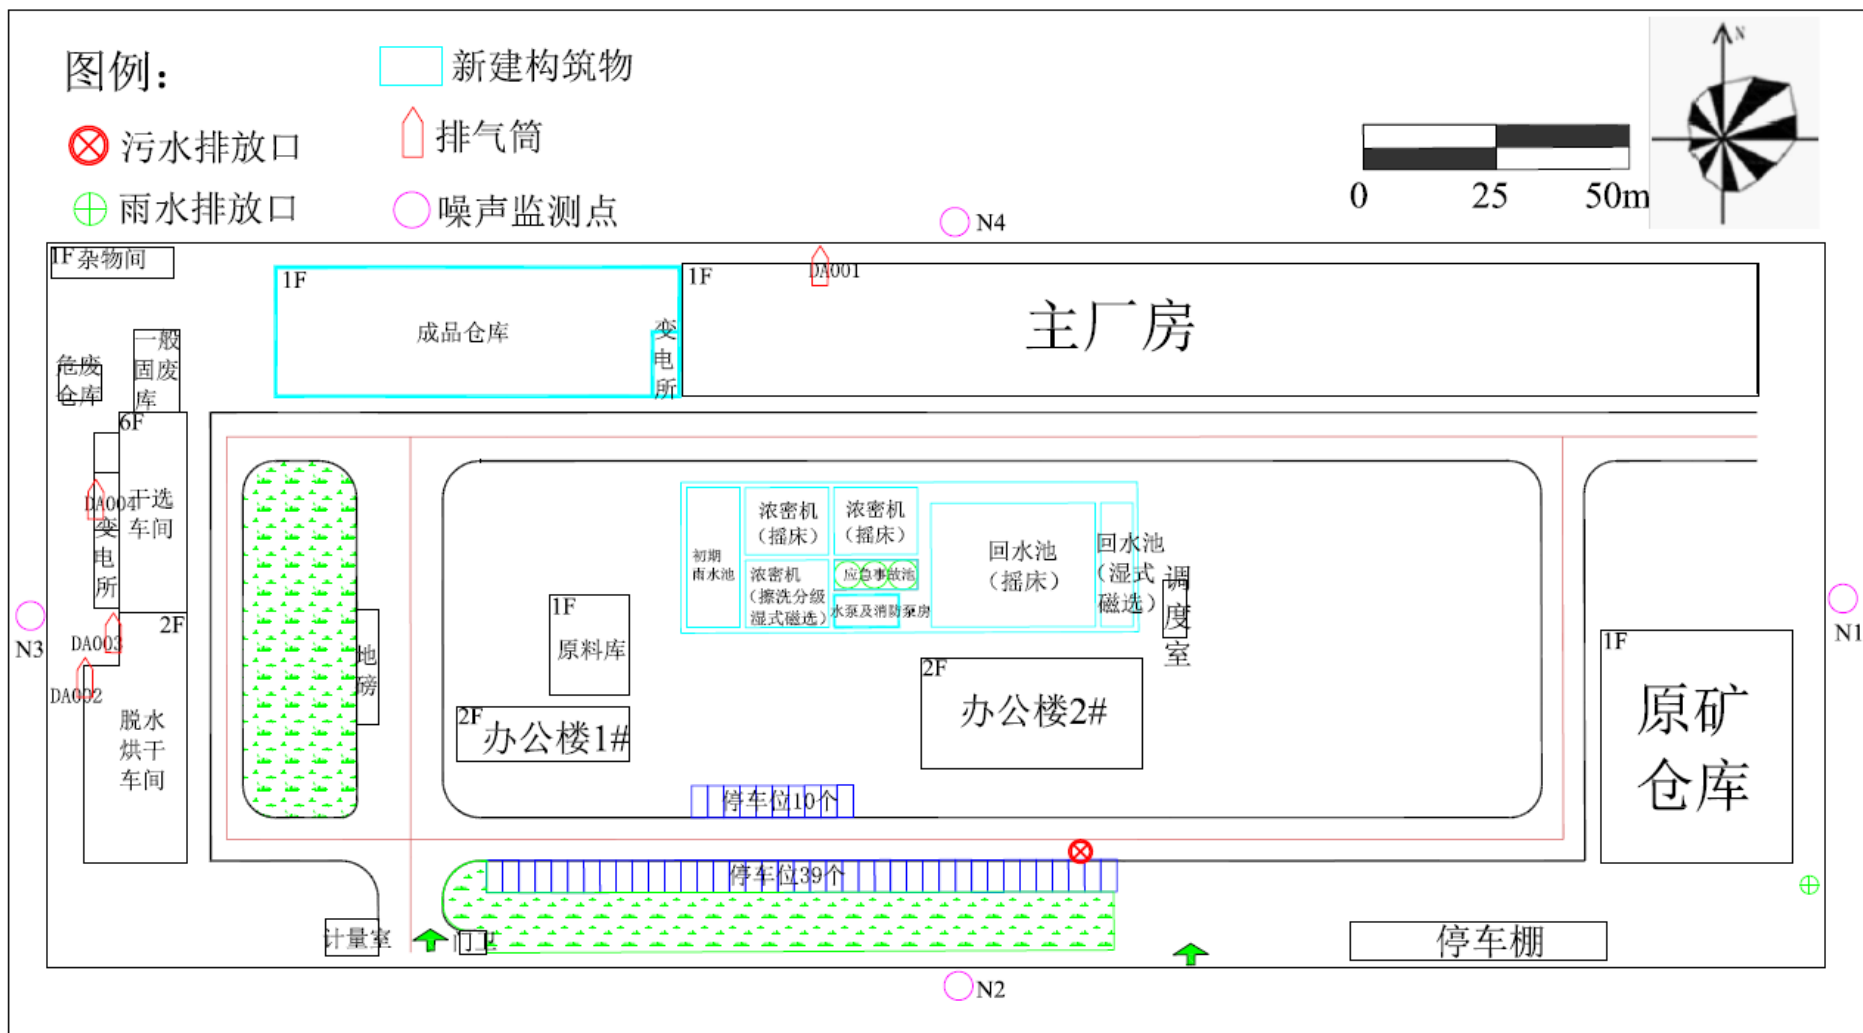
建设项目厂区平面布置图 (含噪声监测点位)
